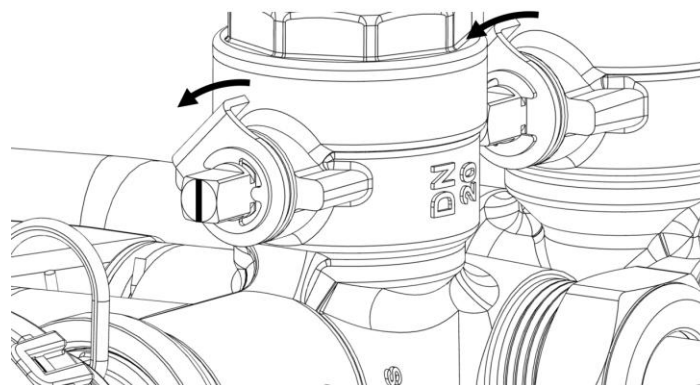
Cv-afsluiter hydraulische unit → BEN
